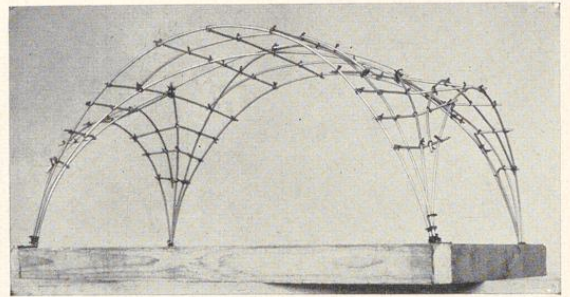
Rundeisengerippe eines Tonnengewölbes mit Stichkappen
